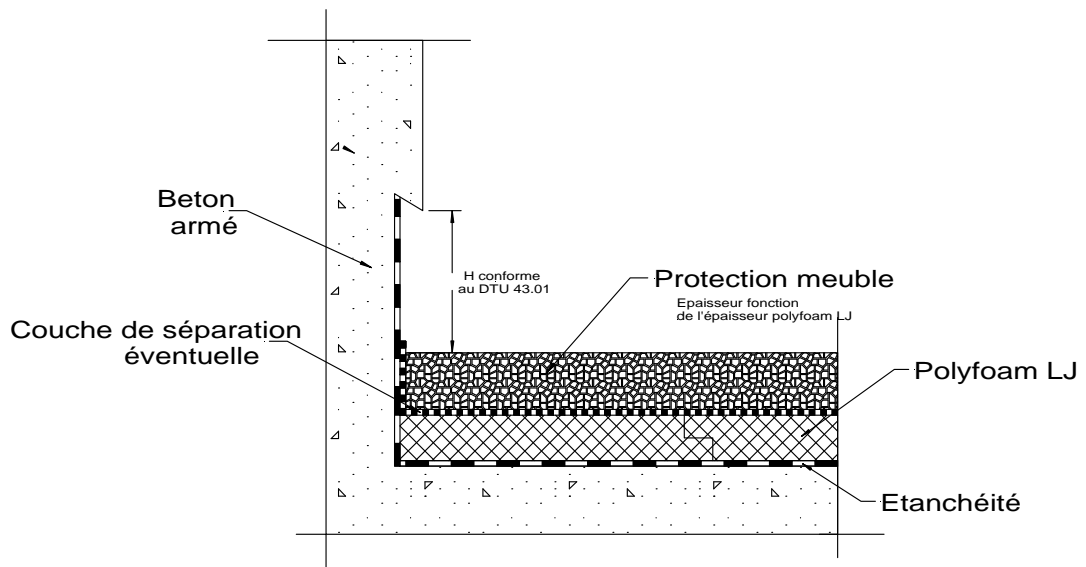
Exemple de relevé sur relief : acrotère en toiture inaccessible à retenue temporaire des eaux pluviales
